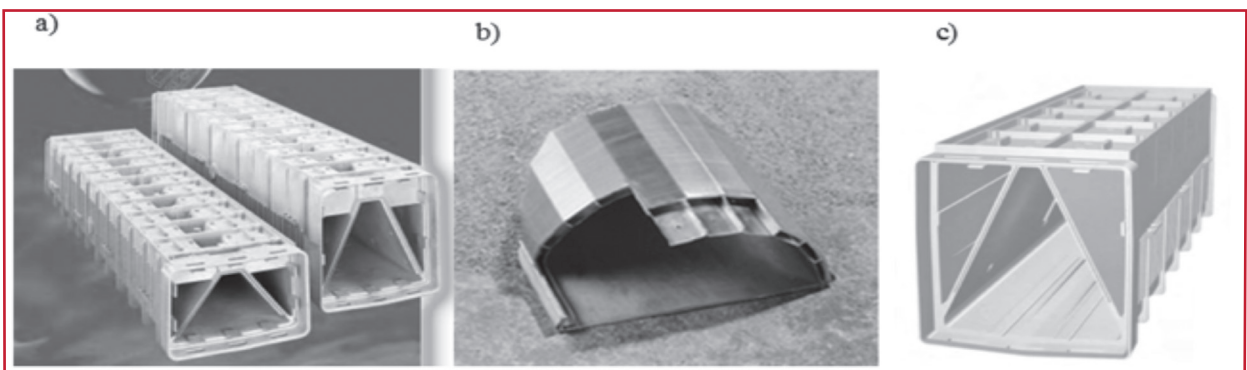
Falso fondo formado a base de losas prefabricadas con boquillas ranuradas de plástico
